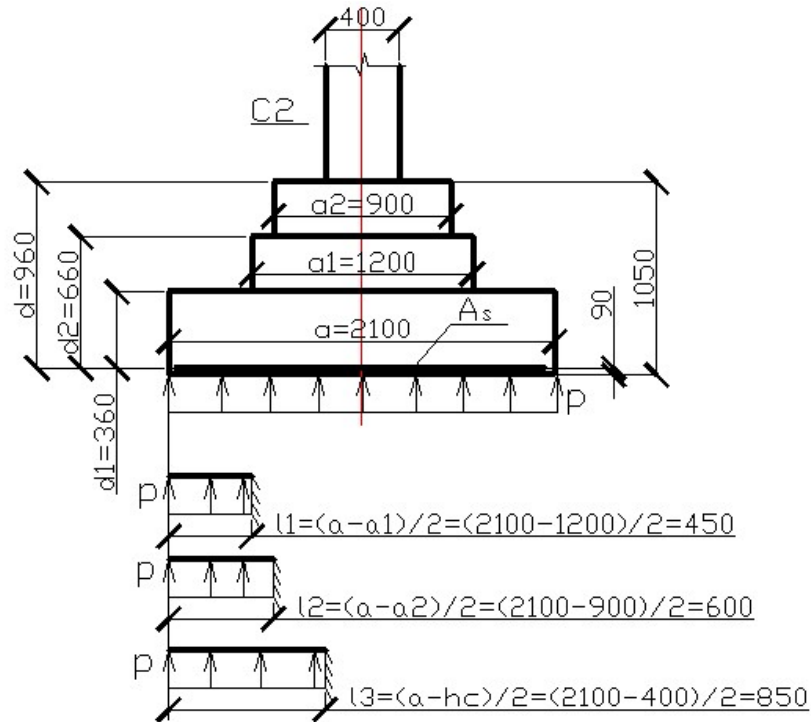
Схема до розрахунку арматури фундаменту
